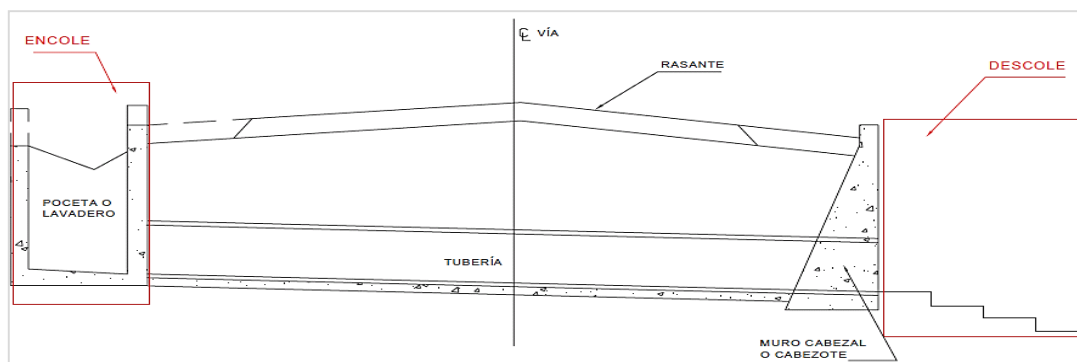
Sección vial con sistema de alcantarillado con encole y descole
